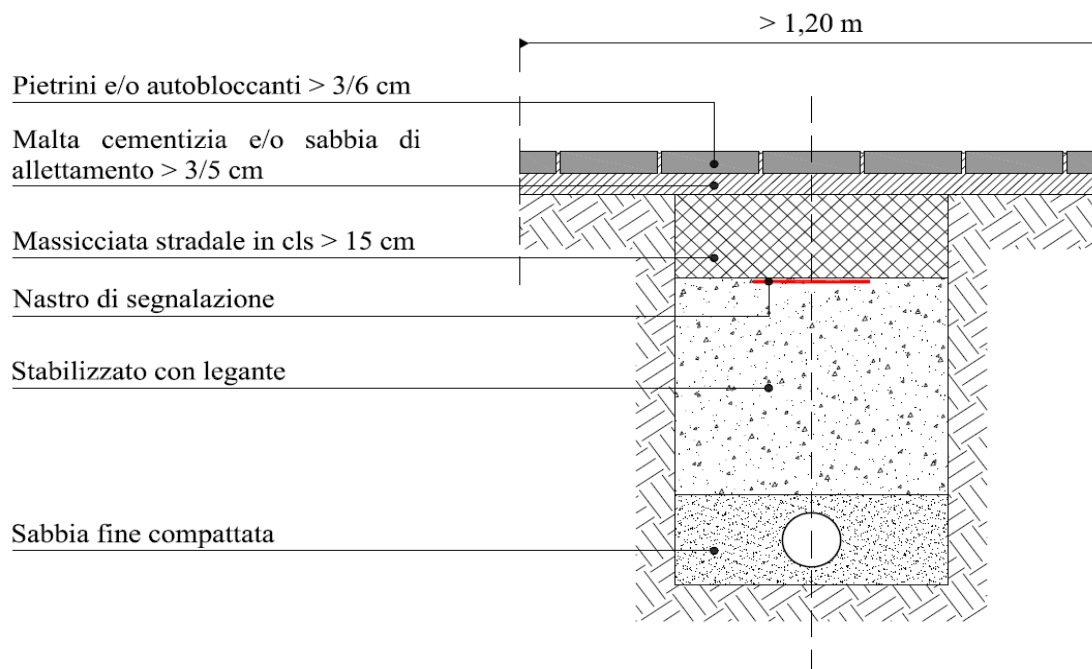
Fig. C – Sezione tipo scavo/ripristino tradizionale su pavimentazioni in pietra/autobloccanti
